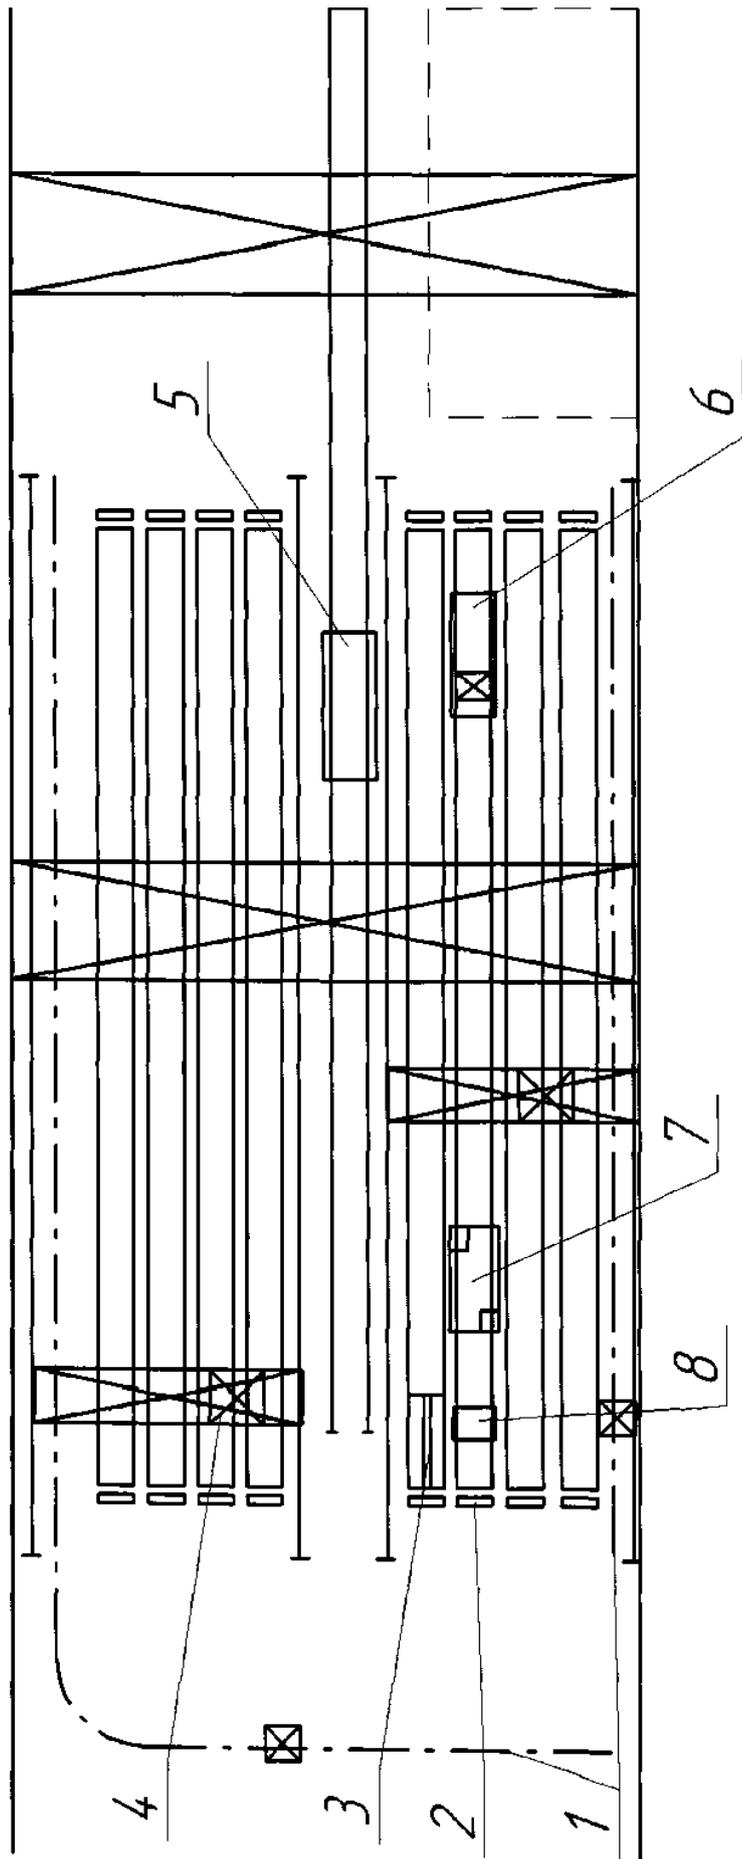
Стендовая линия по производству многослойных плит перекрытий фирмы *Partex*:
